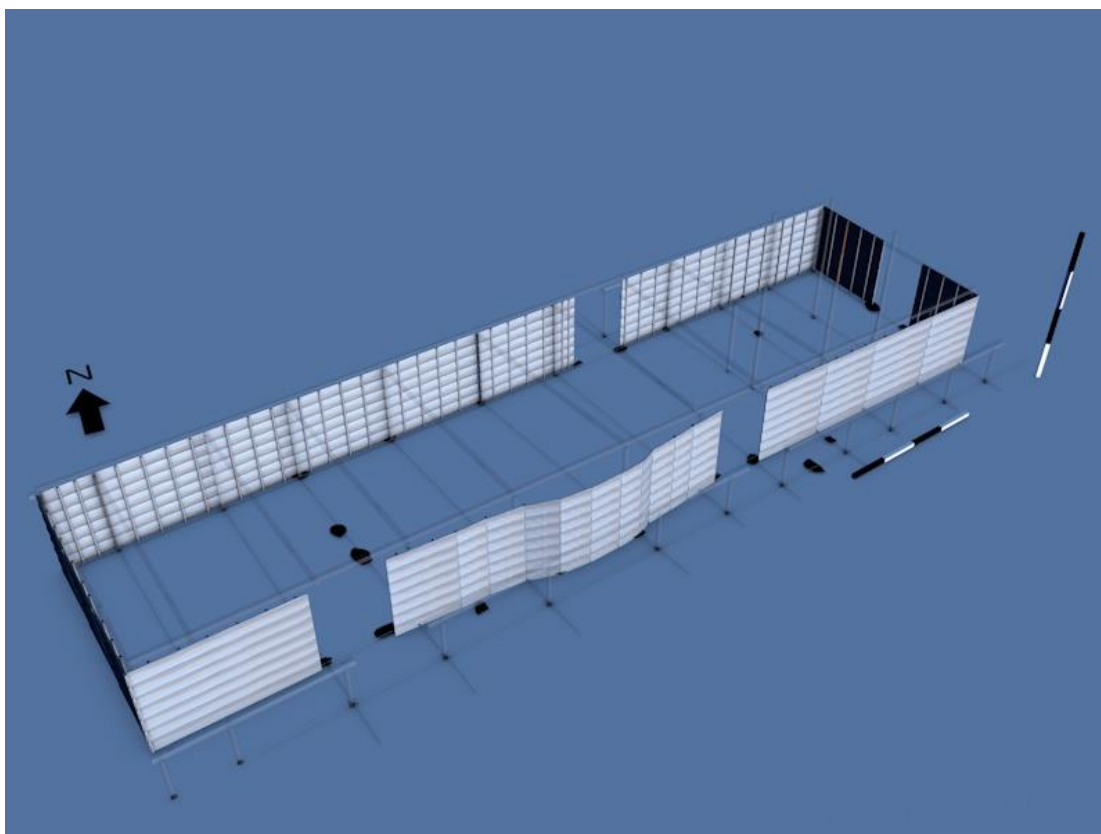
Enkele wandconfiguratie met planken verticaal bevestigd. De planken zijn gedeeltelijk ingegraven en dit is zichtbaar in de vorm van een wandgreppel.
